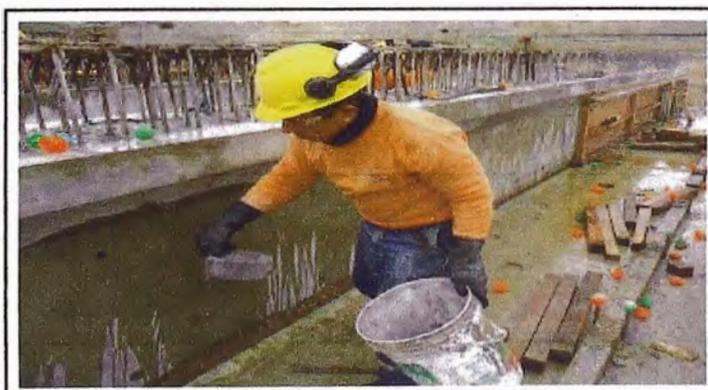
Desencofrado y curado de vigas prefabricadas en taller.
